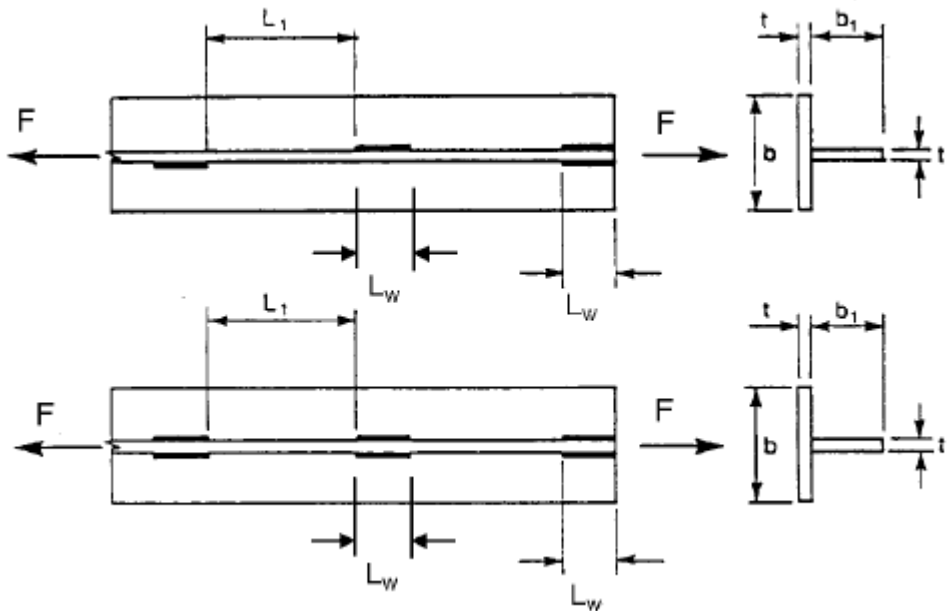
Comprimentos dos cordões em soldadura descontínua
